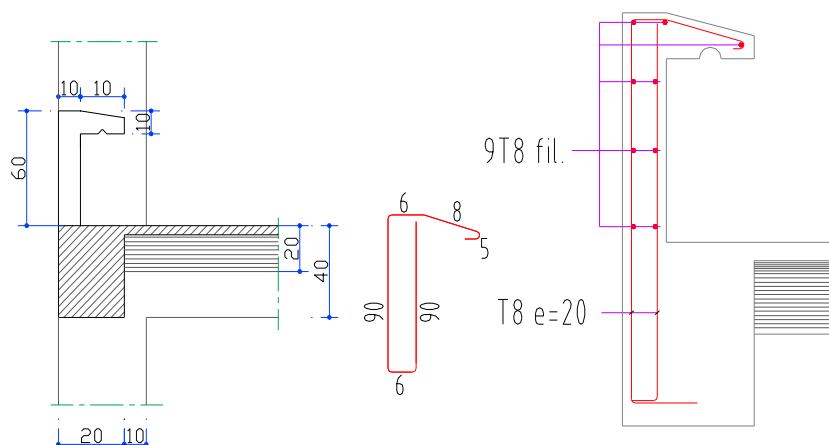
Schéma de ferrailage de l'acrotère.
